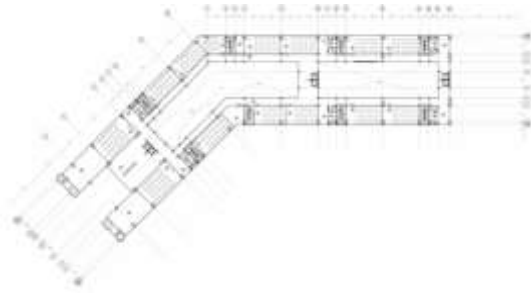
Denah lantai 5 Sekolah Tinggi Parwisata Semarang
